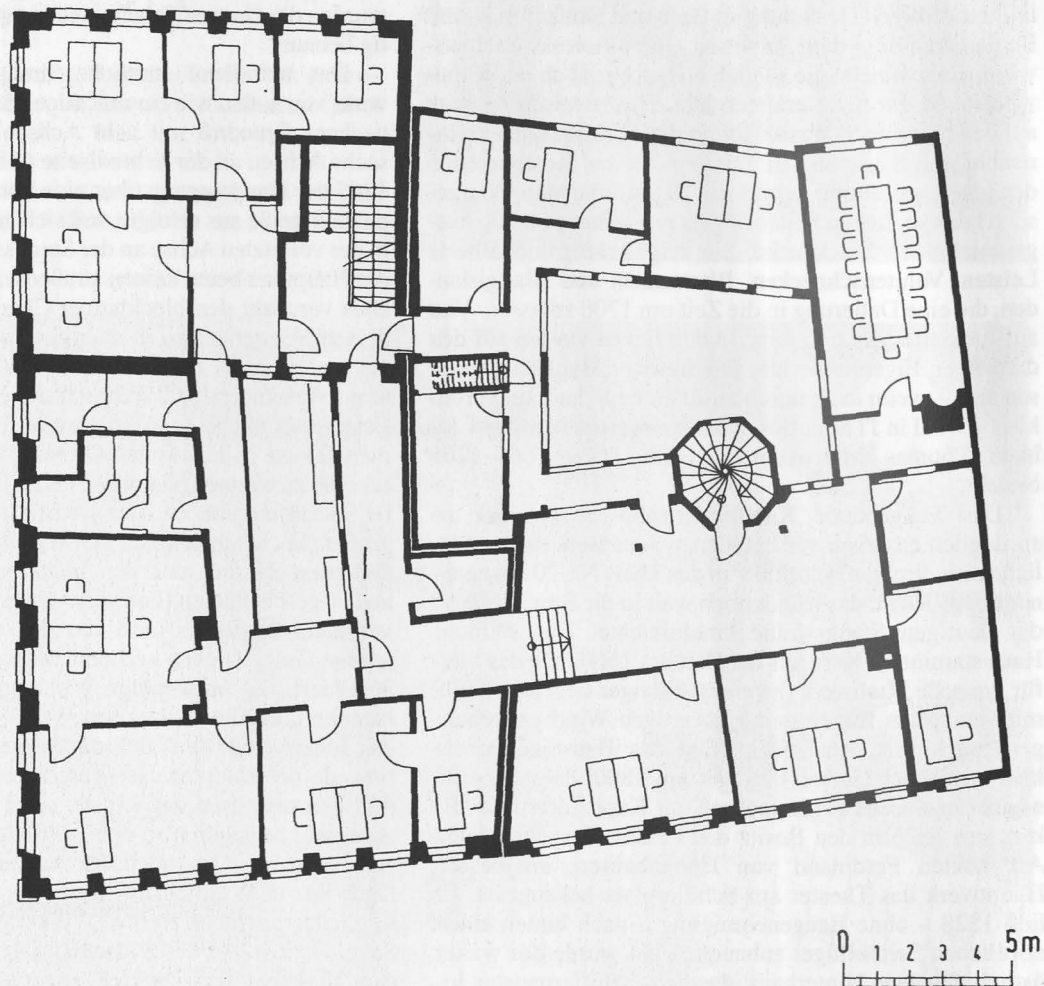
Gebäude Kapuzinerstraße 20 und 22. Grundriß des ersten Obergeschosses (Planzeichnung: Staatliches Hochbauamt)
